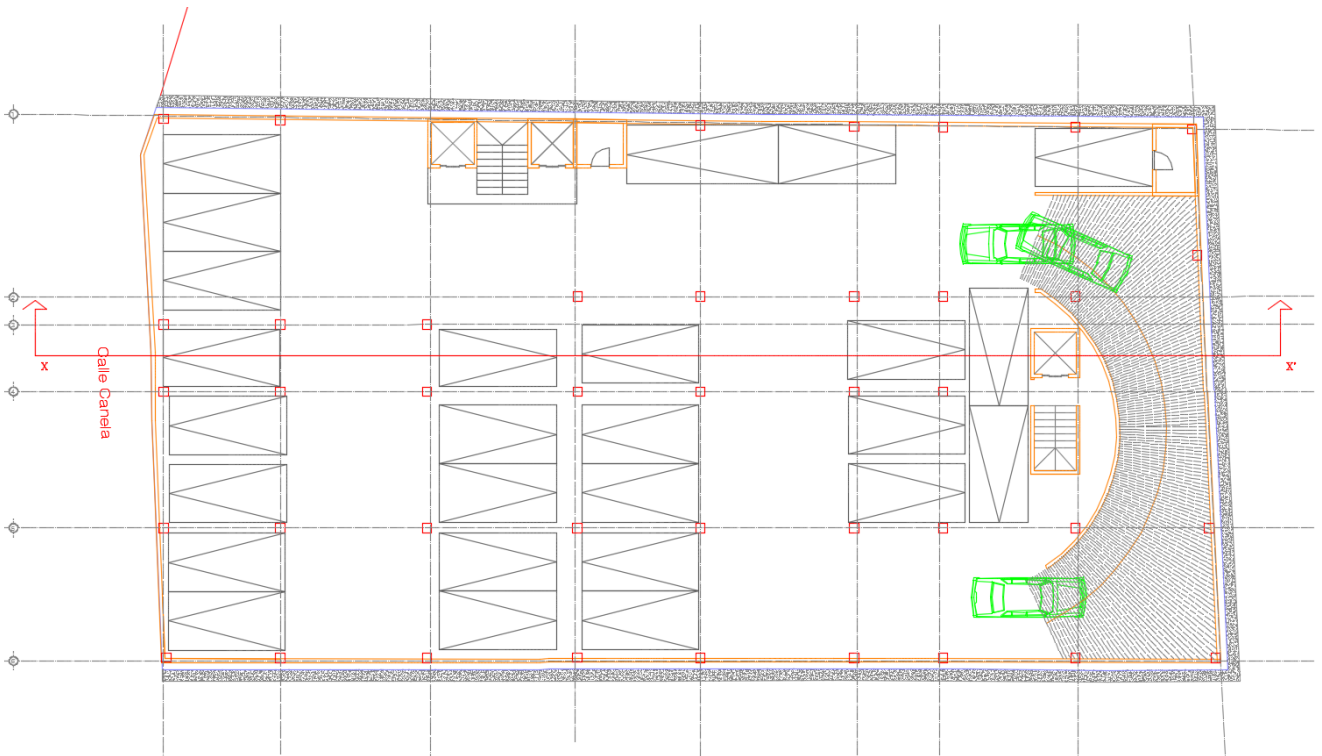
PLANTA ARQUITECTÓNICA SÓTANO 2
